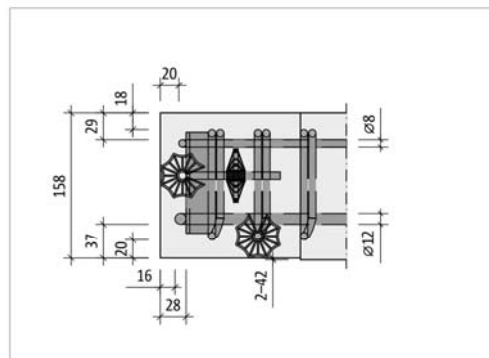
Schöck Tronsole® Typ Z: Seitenansicht einer Auflagerkonsole mit eingebautem Tragelement
